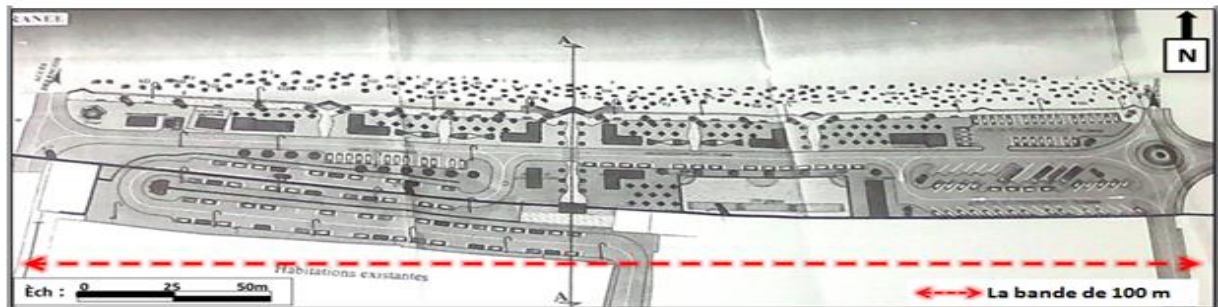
Plan d'aménagement de la plage de Ben Saïd
